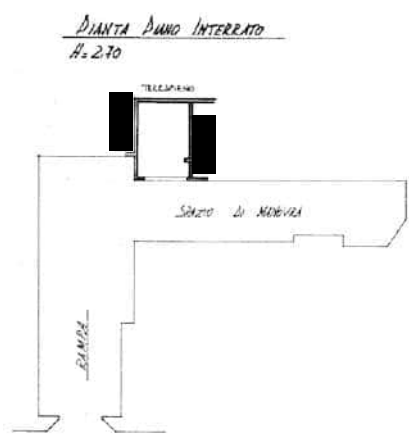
Planimetria catastale del box garage sub 60 (cfr. All. 5c)
